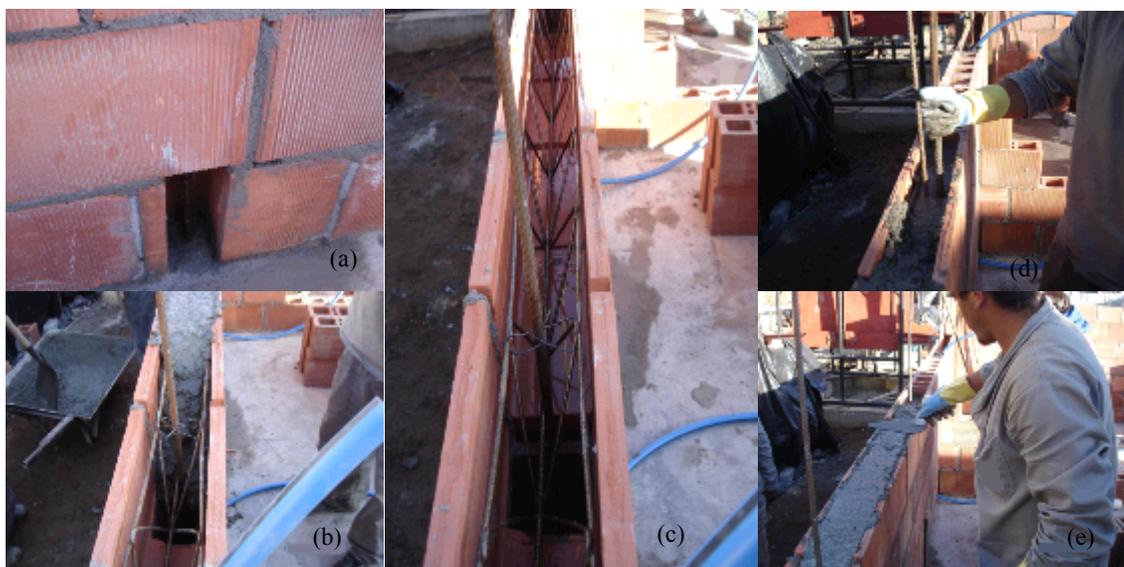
(a) janela de inspeção com armadura colocada; (b) grauteamento do pilarete e da calha da janela; (c) posicionamento da treliça na calha da janela; (d) vibração do graute com barra de ferro auxiliar; (e) alisamento do graute com colher de pedreiro
